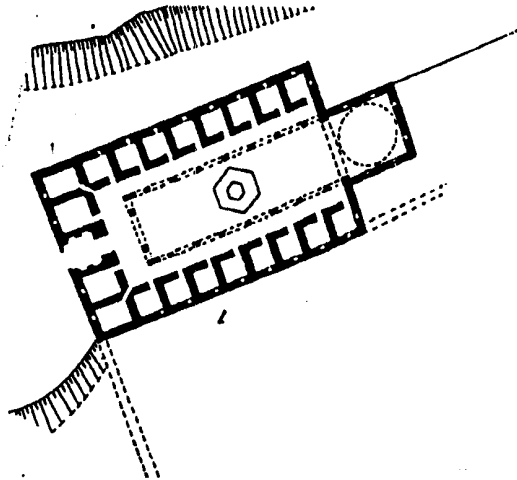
مسقط أفقي لمدرسة سليمان باشا في أزيق
